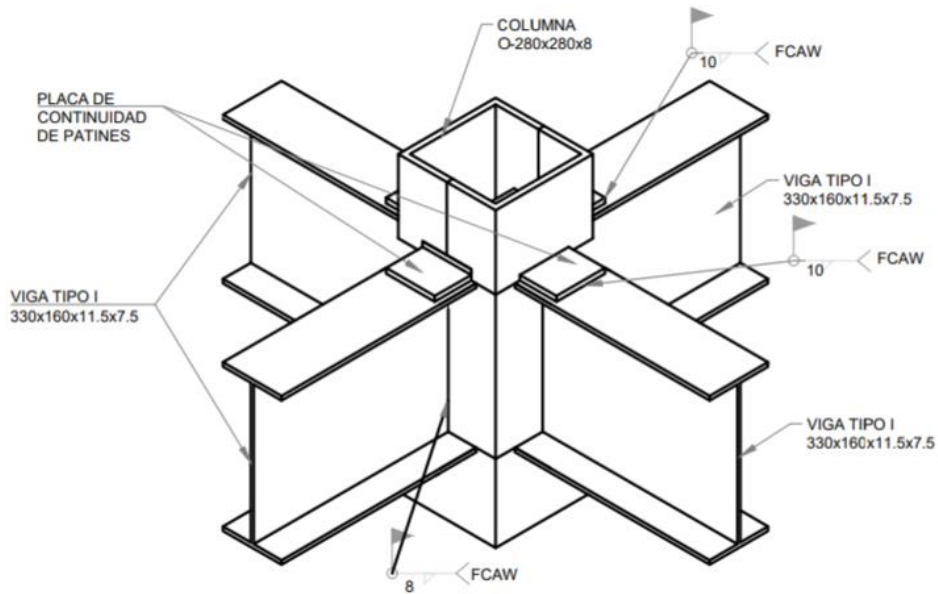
Conexión de vigas con columnas metálicas. Elaboración propia, 2019.
